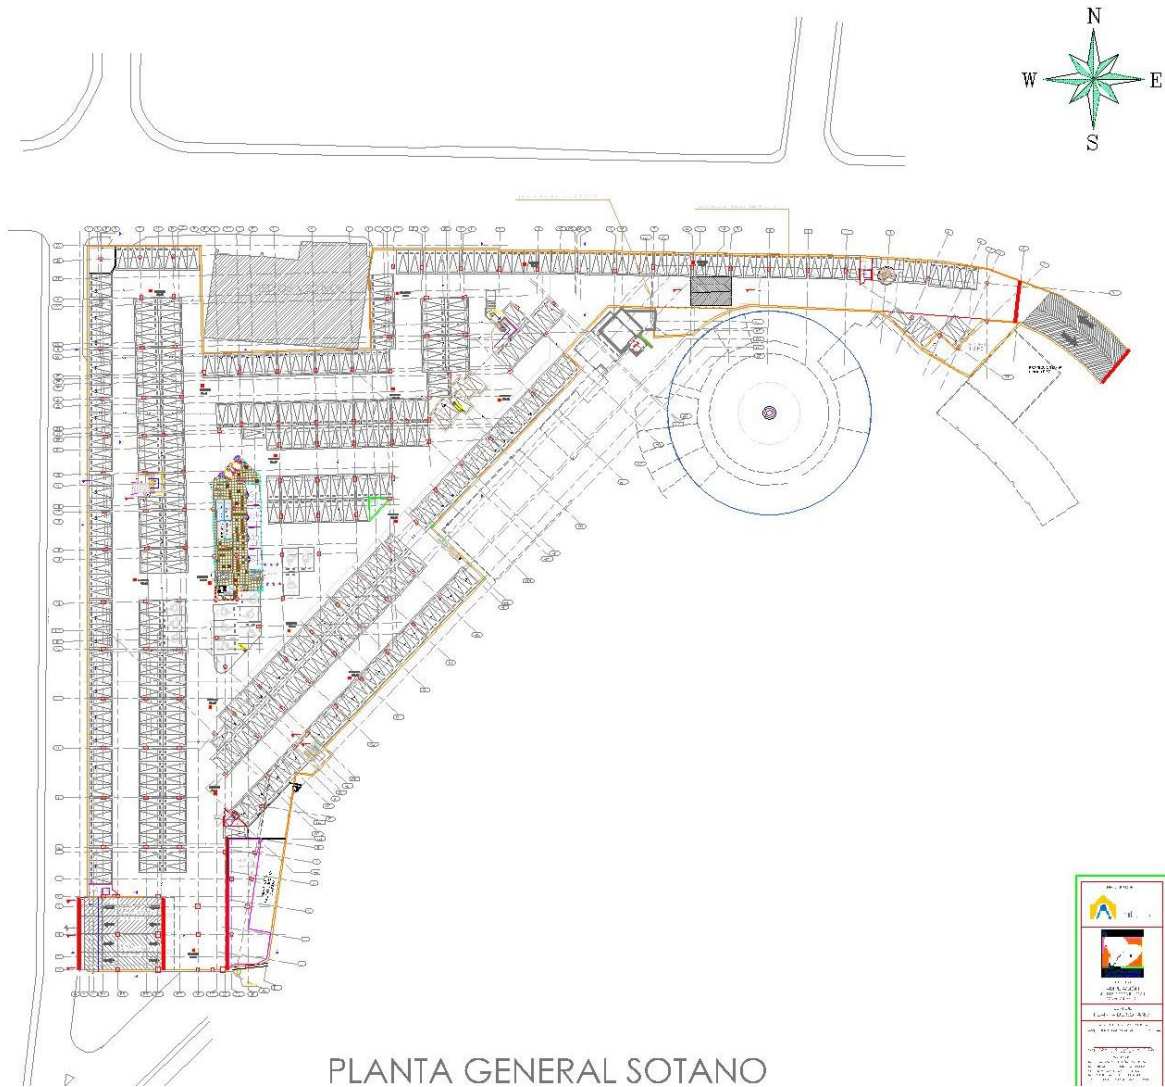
Plano arquitectónico Sótano. (Fuente: Diseños arquitectónicos ARINSA)
